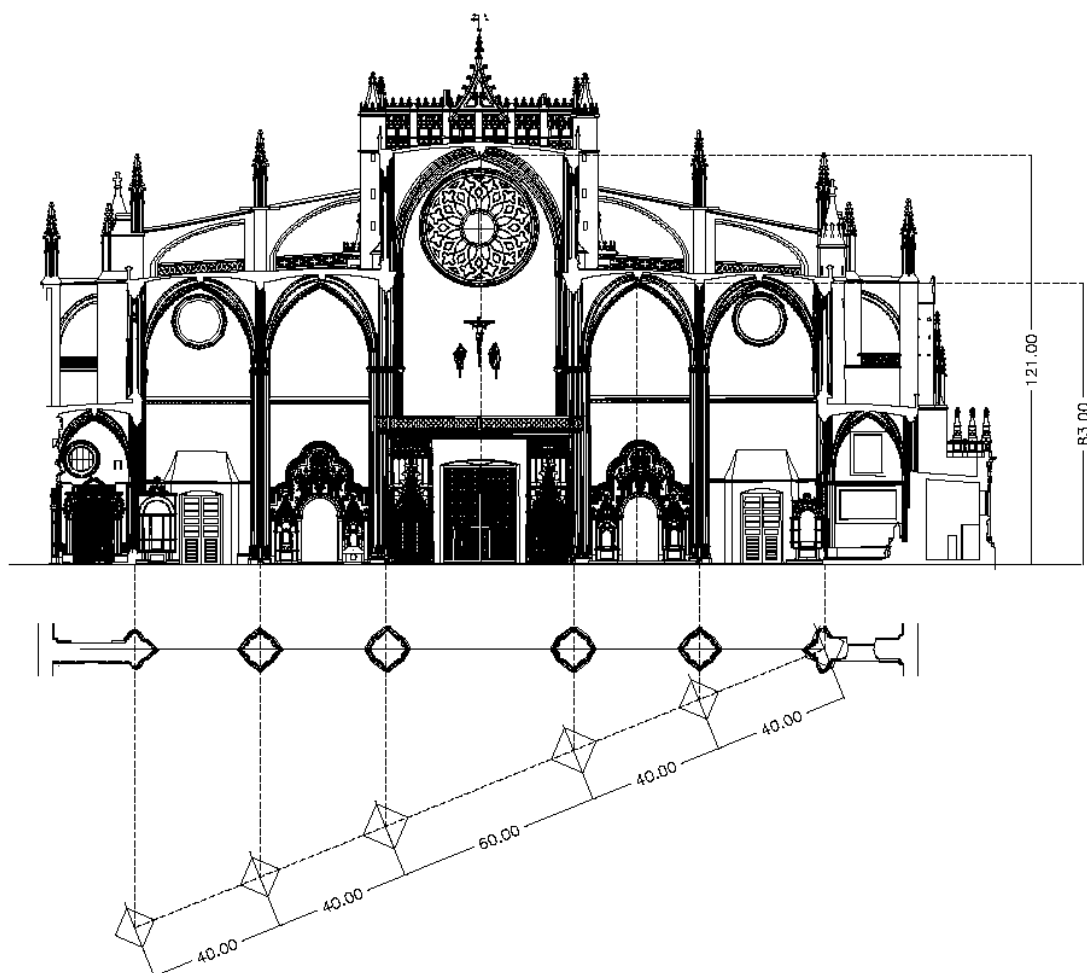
Adaptación del trazado original en planta y sección (figura del autor sobre planimetría de A. Almagro).
